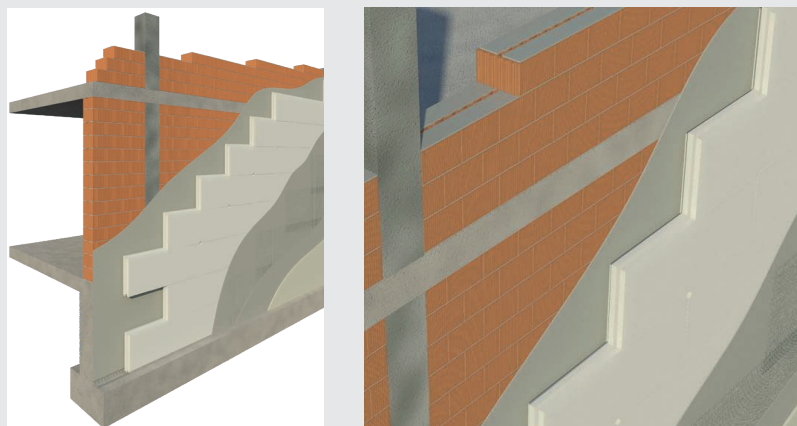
Fachada de una sola hoja de Termoarcilla con SATE: Muro de Termoarcilla + Fijación + Aislamiento + Capa base de armadura (mortero de armadura + malla de fibra de vidrio) + Capa de acabado. Aislamiento térmico continuo por delante de la estructura. Solución sin puentes térmicos
